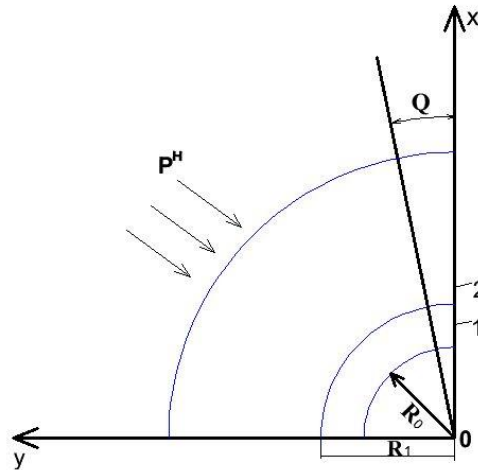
Схема к расчёту монолитной крепи выработки круглого сечения
